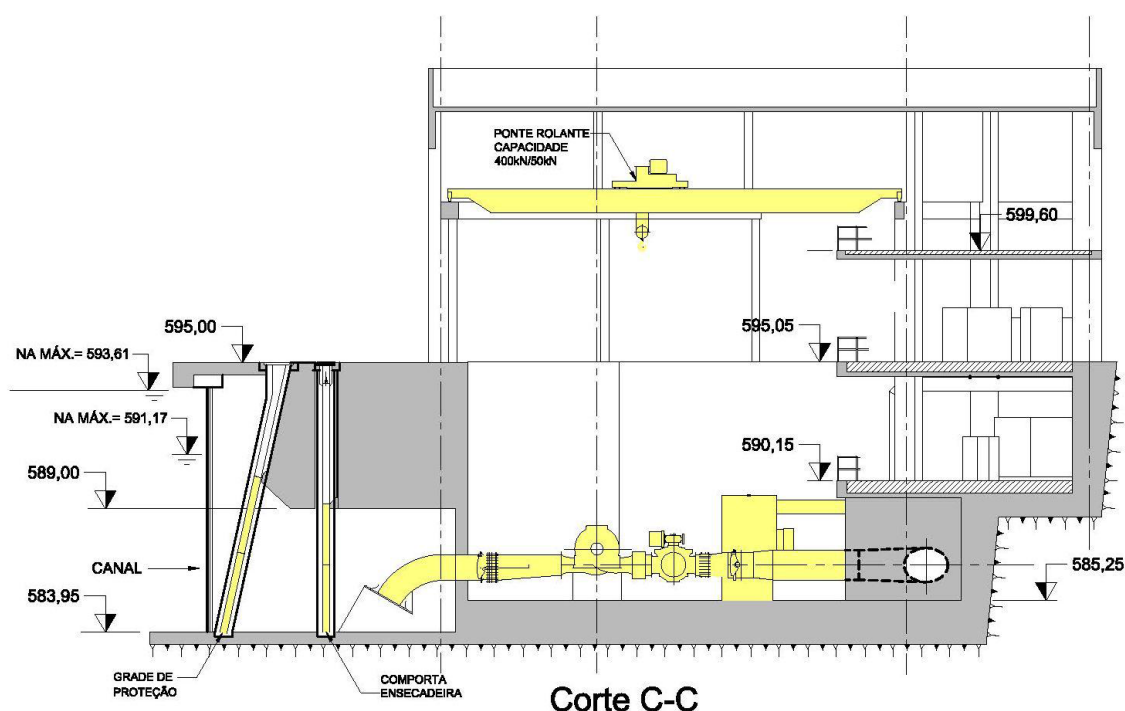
Arranjo da Instalação dos Conjuntos Moto Bombas - Corte
